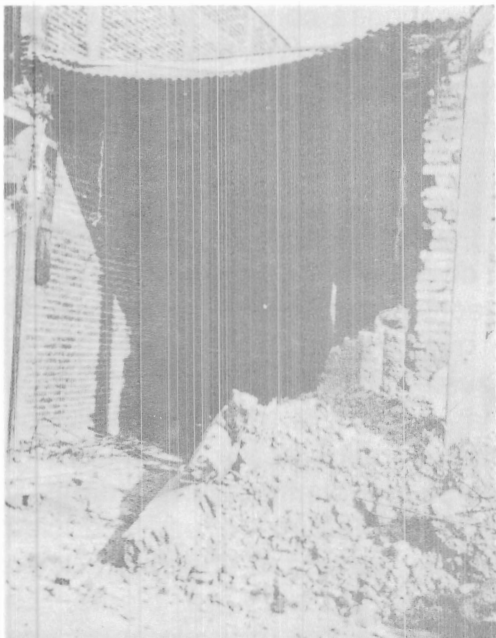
Inadecuada conexión de muros de mampostería con elementos confinantes (López y Teshigawara, 1997).
